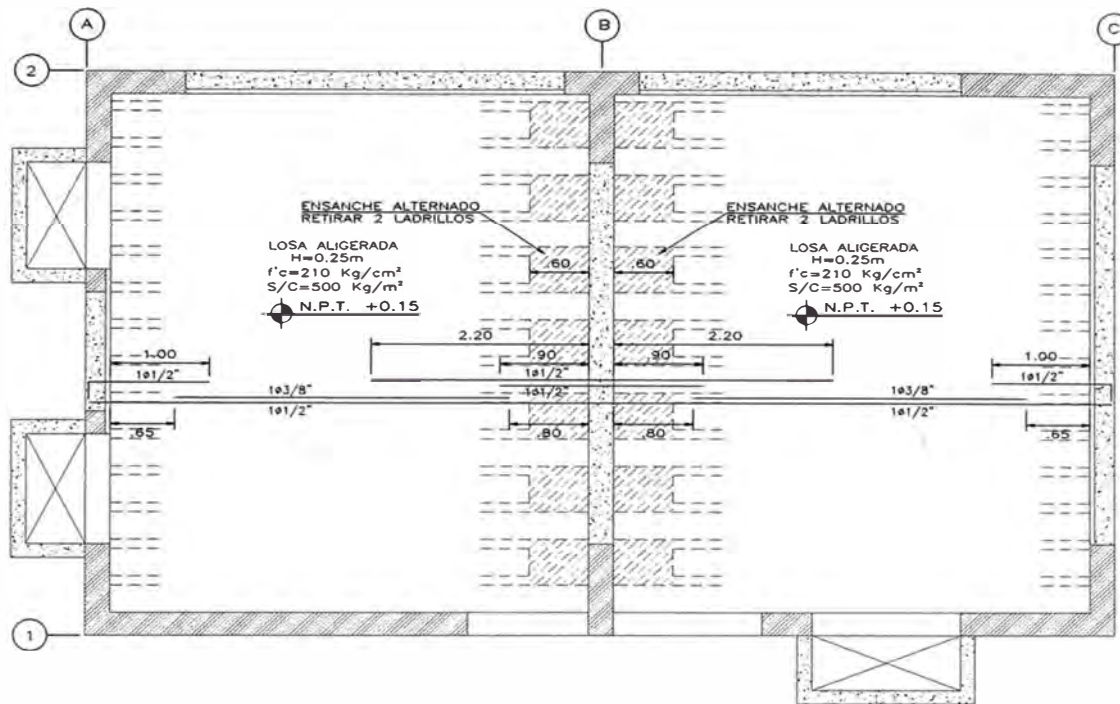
Distribución del refuerzo en la losa aligerada.
